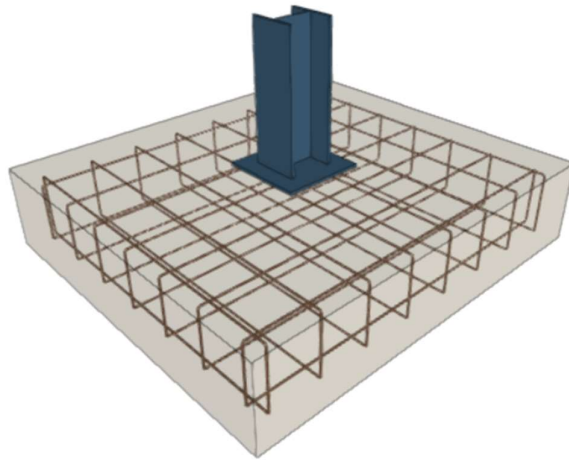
Zapata tipo pilares de fachada nave almacén/vestuarios.
